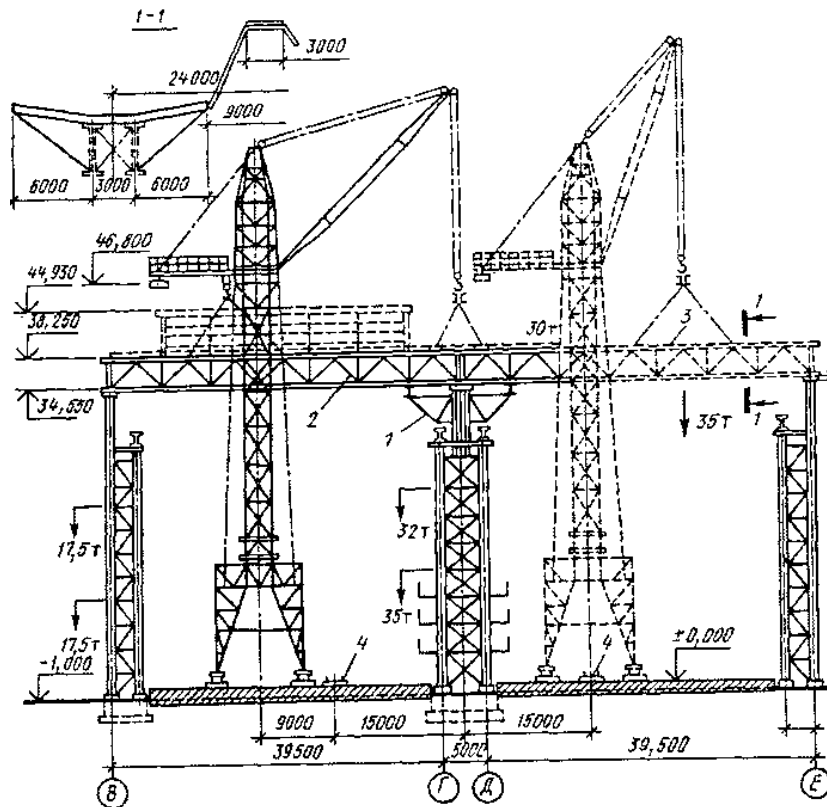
Приклад схеми монтажу покриття елінгу за допомогою тимчасової монтажної опори.
